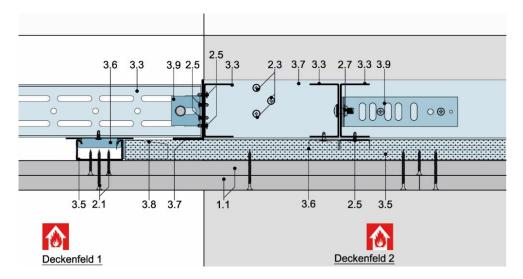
Flurkreuzung einer Weitspannträgerdecke mit durchgehender zweilagiger Beplankung
